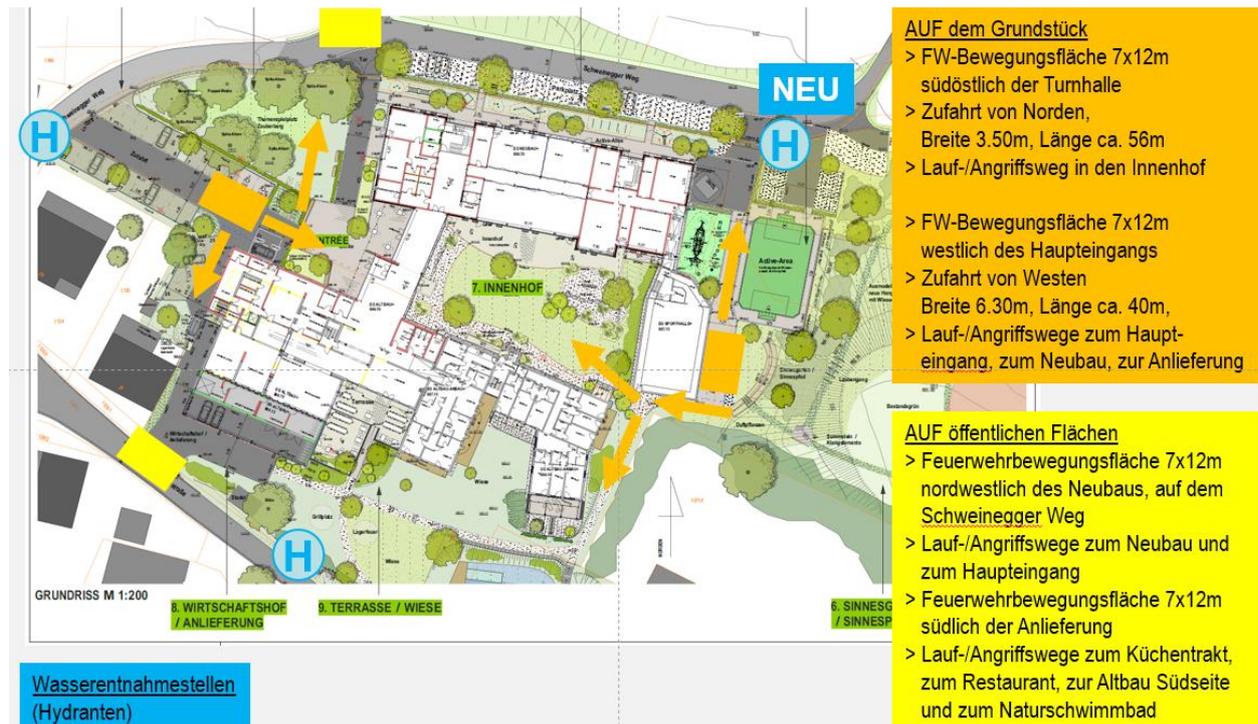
Feuerwehzufahrten und vorläufig geplante Lage des neuen Hydranten
